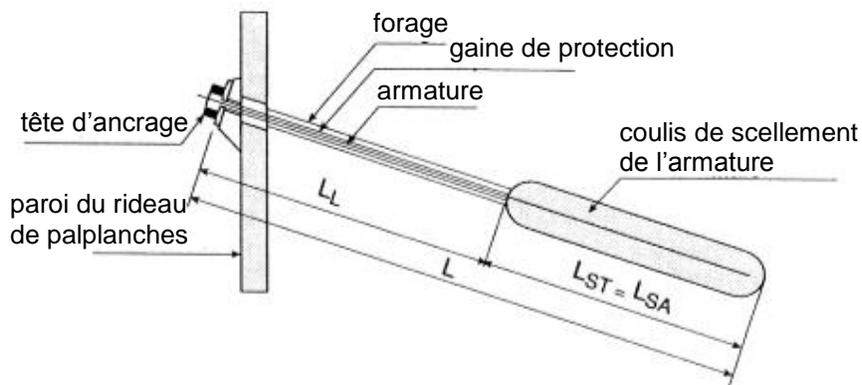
Schéma d'un tirant d'ancrage fixant le rideau de palplanches
